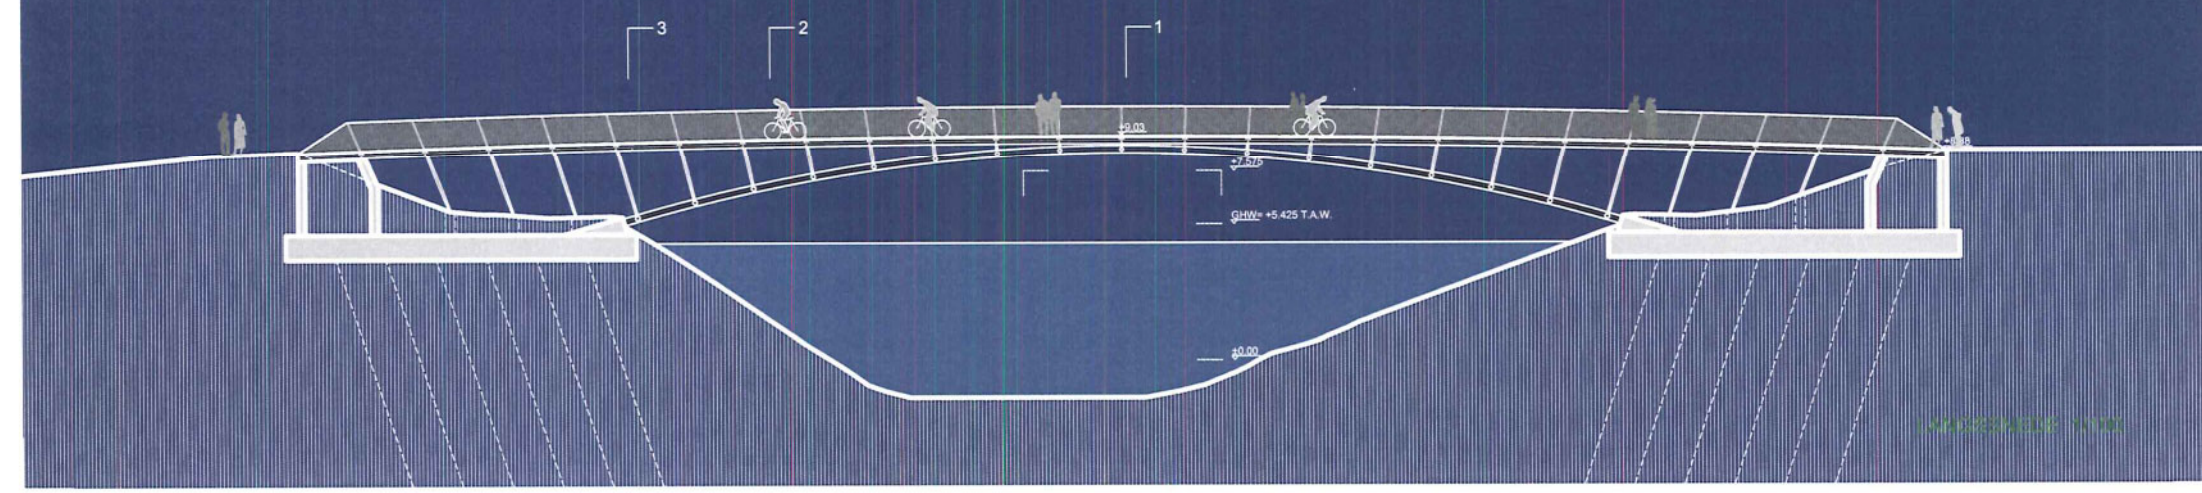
/50 LANGSSNEDE ZIJAANZICHT
